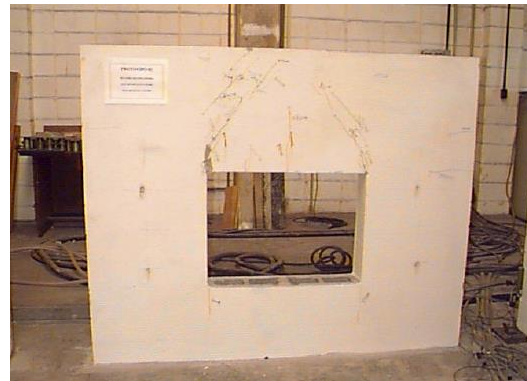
Agrietamiento de muro con abertura sin refuerzo (Lopes, 2001).
